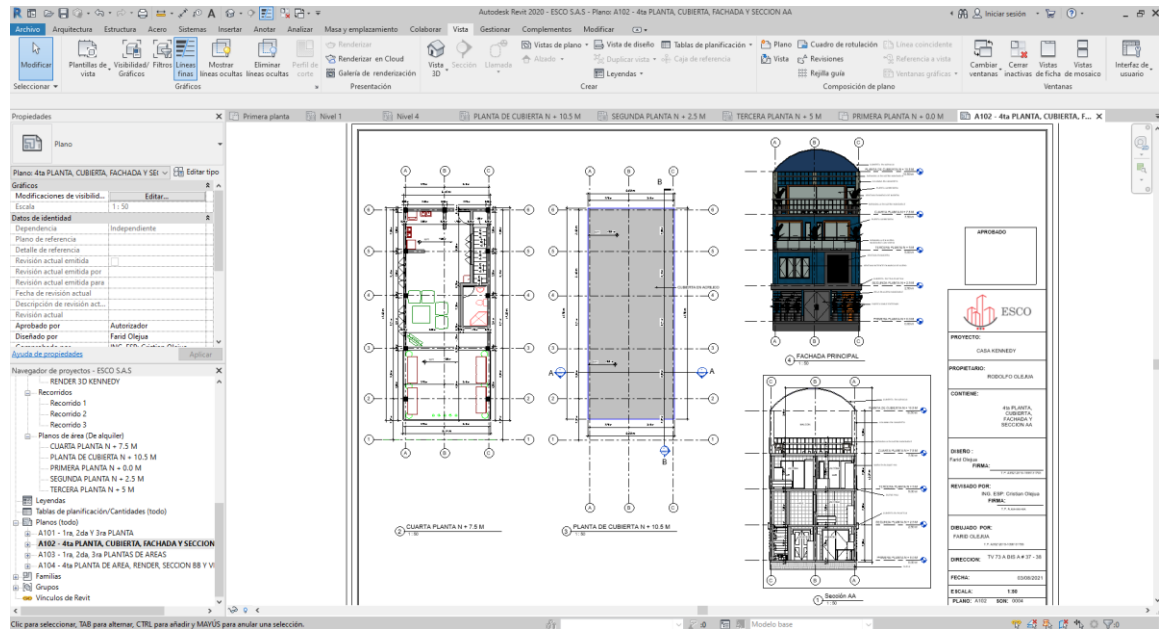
Cuarta planta, cubierta y frente de vivienda. Revit. Fuente elaboración propia.
